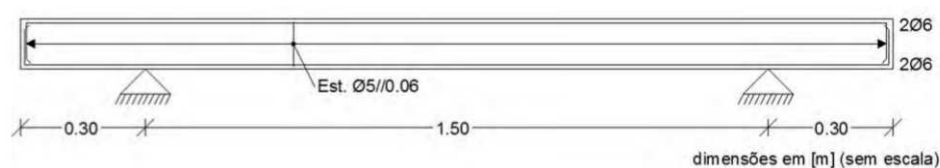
Distribuição longitudinal das armaduras das vigas. (Adaptado de [20].)
